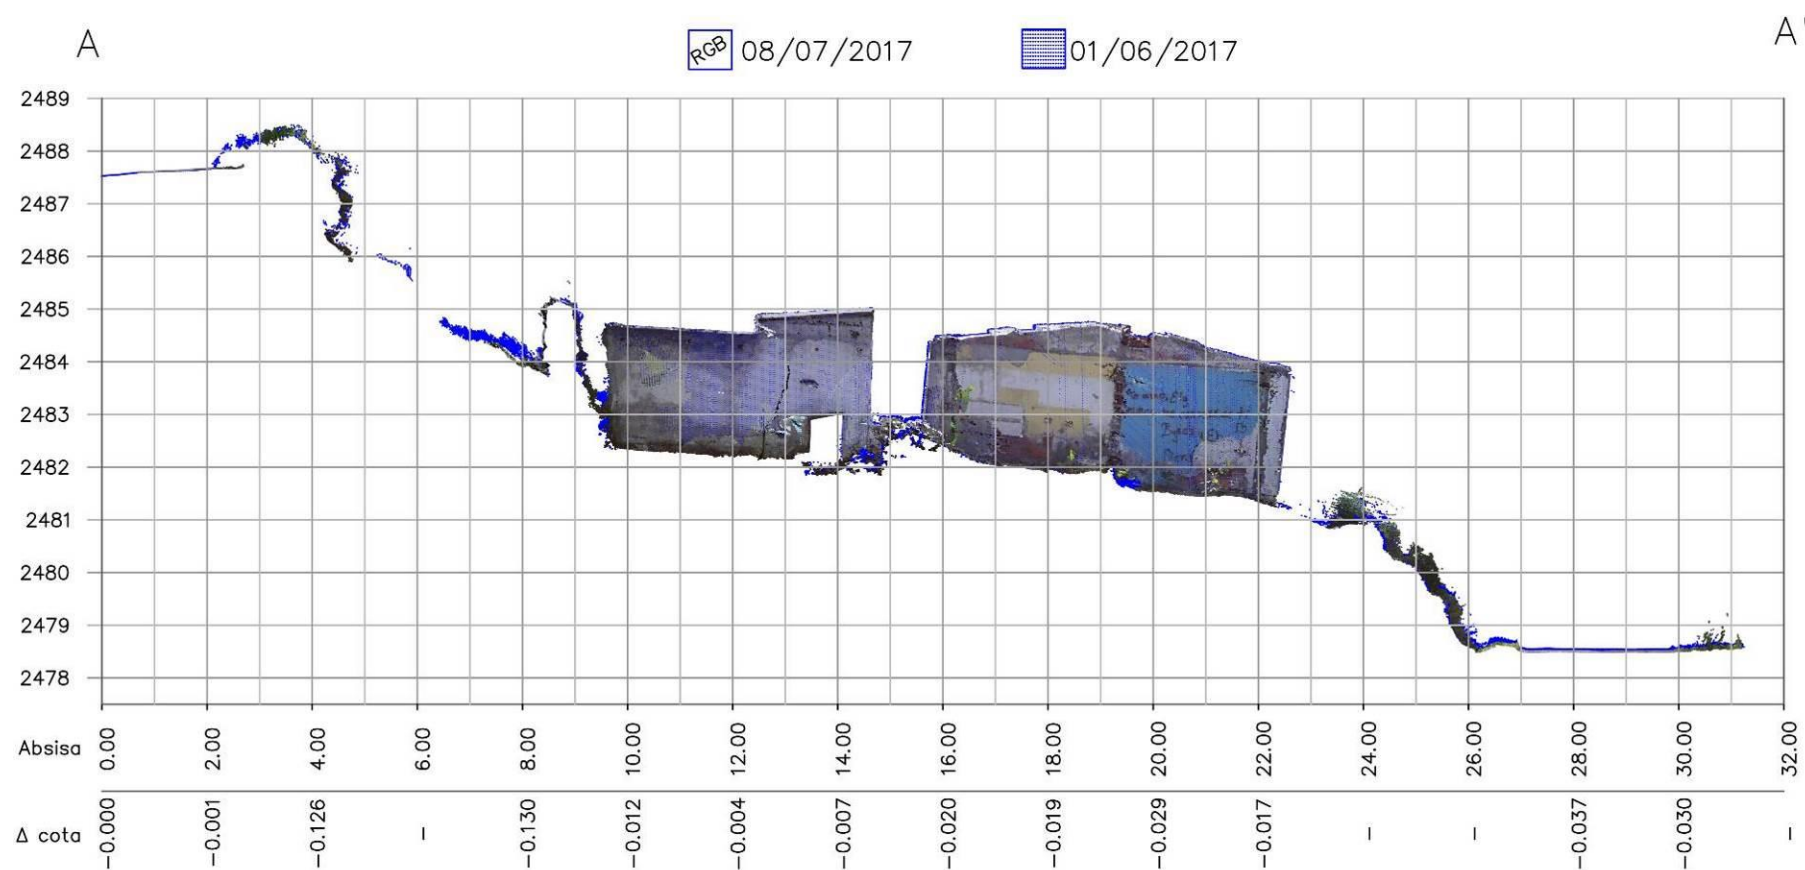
Levantamiento 2 vs levantamiento 3, perfil A-A'.
